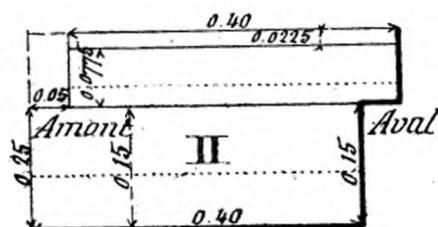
g. — Vue latérale de la pièce latérale inférieure du radior.
